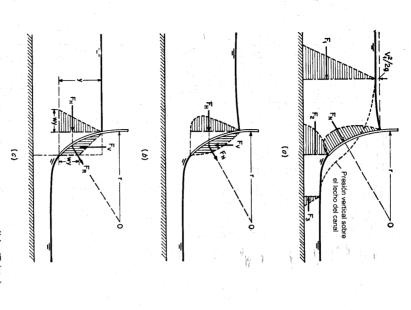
Determinación de presiones para compuertas radiales (Tainter).
